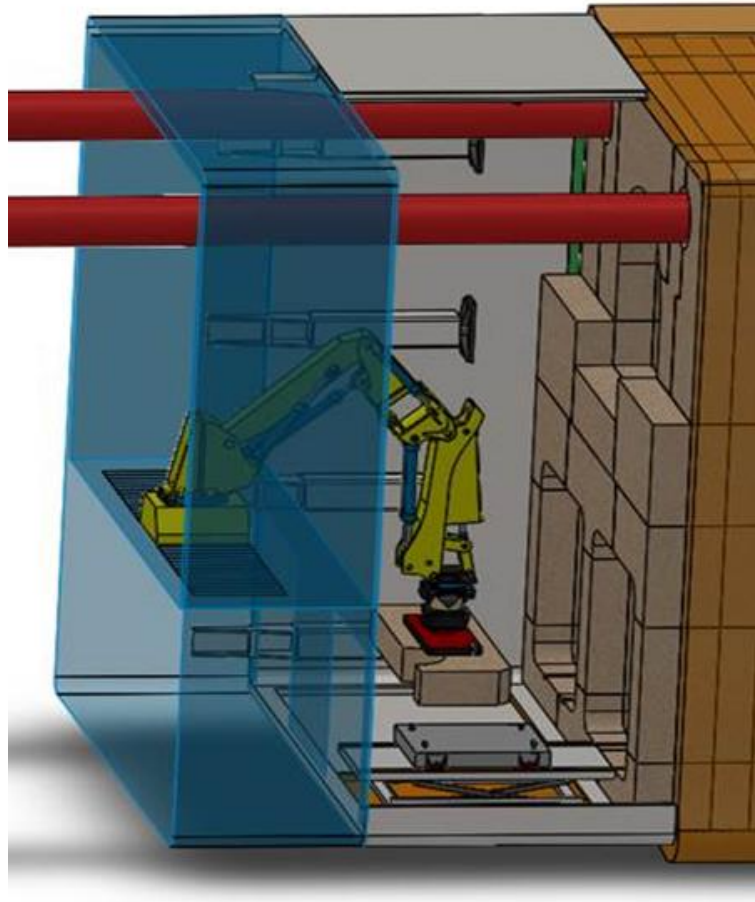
Fertigteillösung (Alternative zur Ortbetonbauweise)
